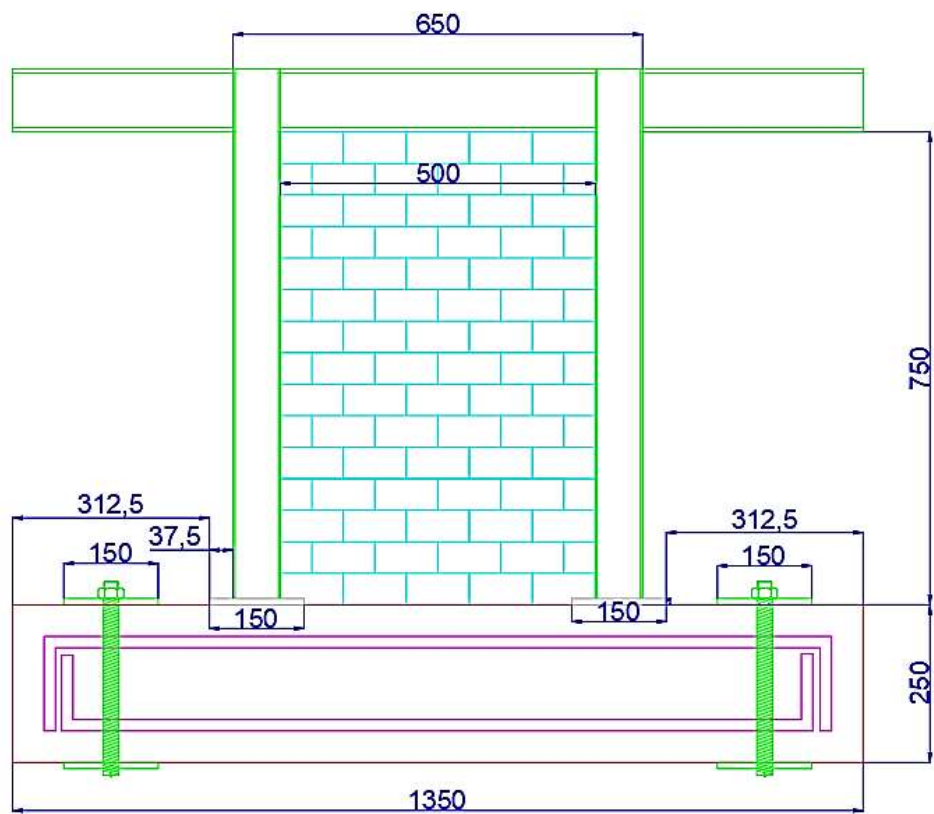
Pórtico de acero estructural de 50cm x 75cm con relleno.
